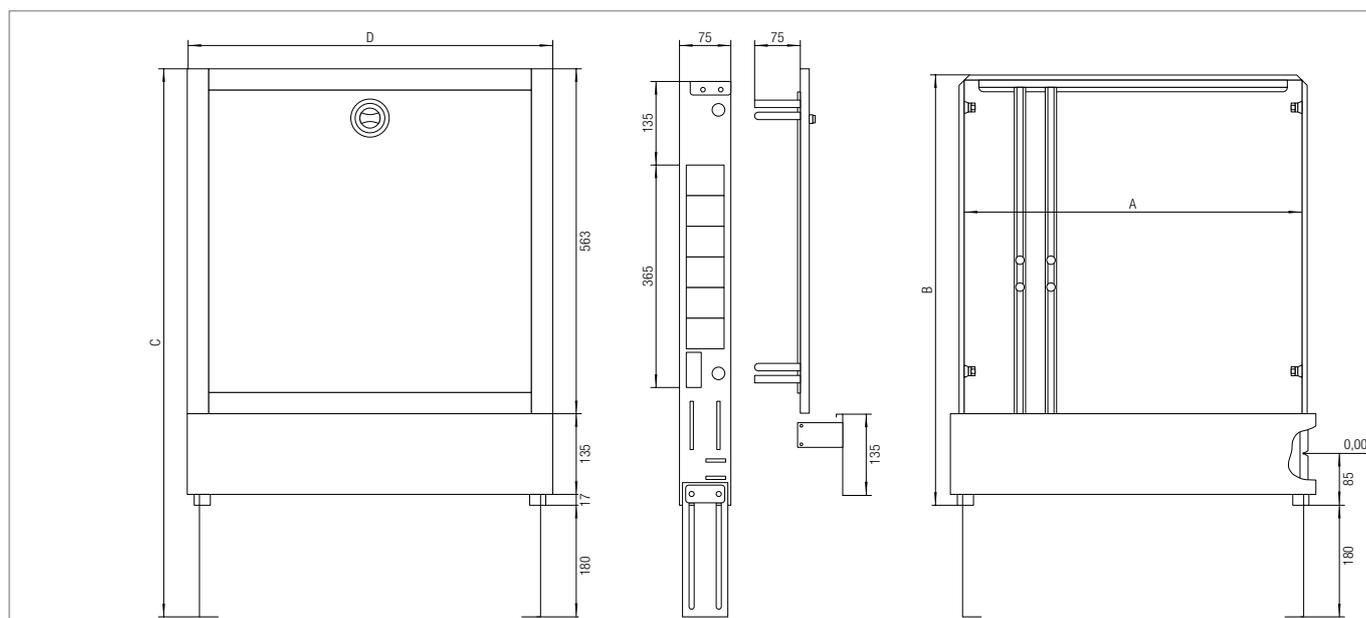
Dimensions coffret pour collecteur UP 75
